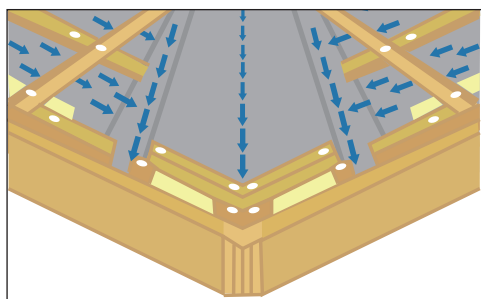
Сомнительная конструкция: крепление обрешётки к настилу ендовы снижает надёжность конструкции от протечек талой воды
